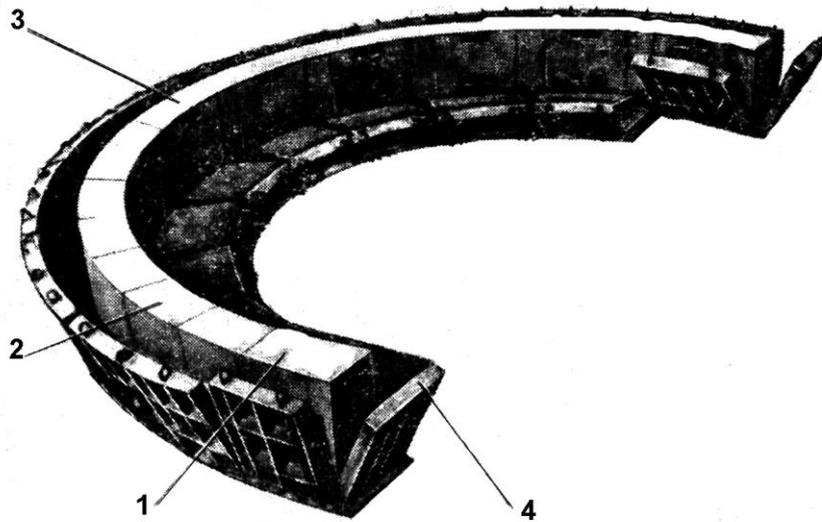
Контрольная сборка блочной обделки для переустройства двухпутного тоннеля: 1 – блок фундамента; 2 – блок стены; 3 – блок свода; 4 – металлическая опалубка
